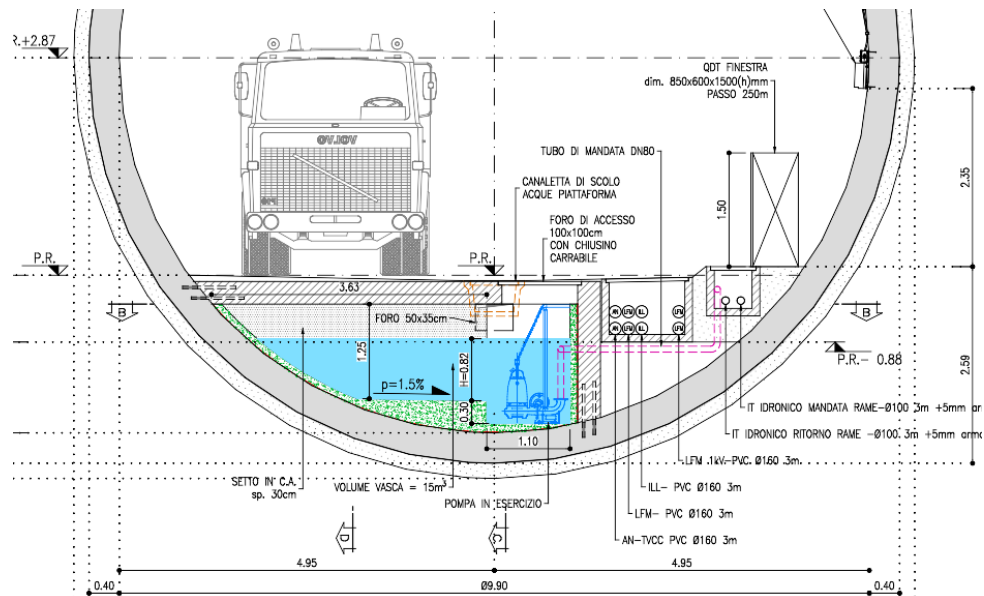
Sezione vasca di accumulo e sollevamento Forch
